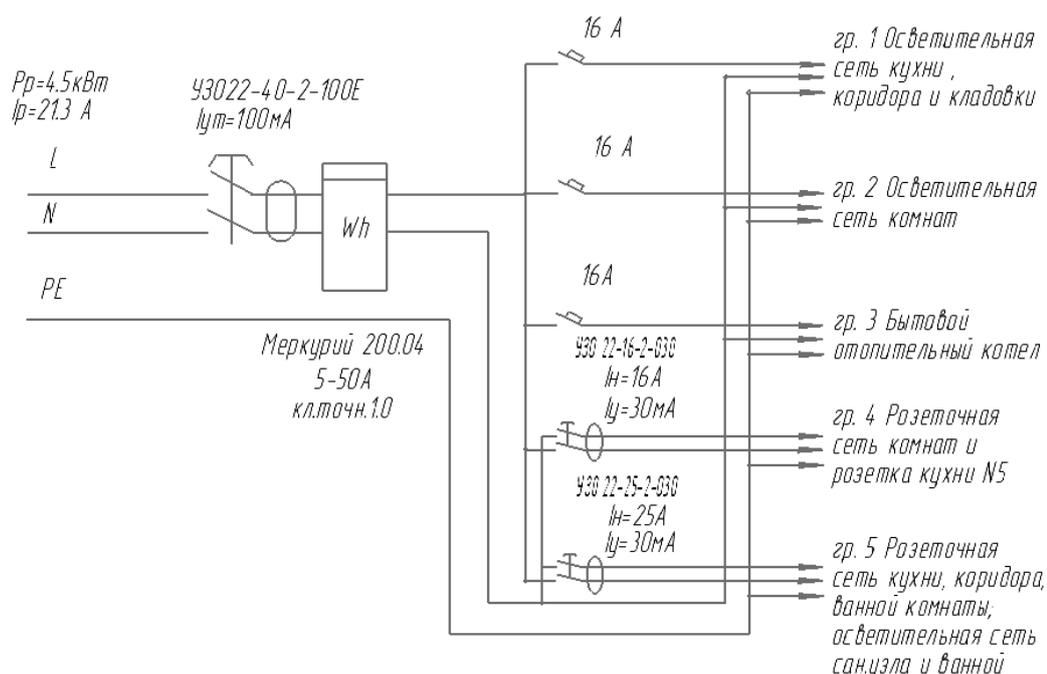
Типовая схема электроснабжения квартиры в жилом многоэтажном доме
